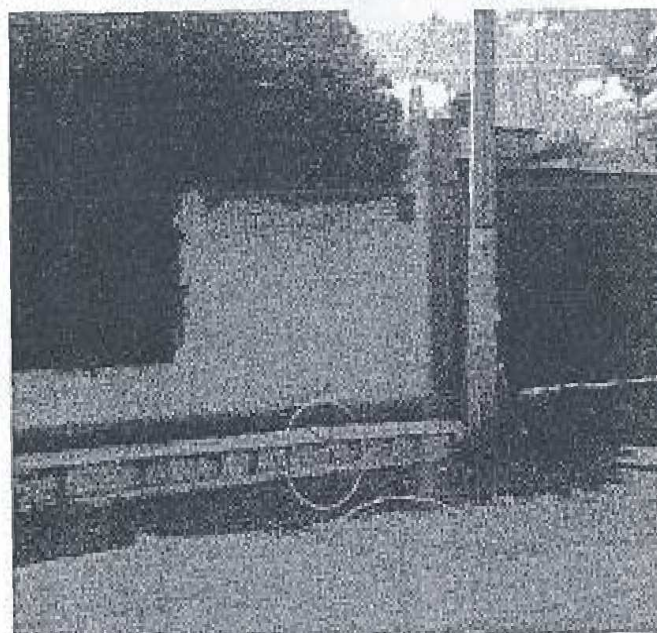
Fisura en la banqueta y muestra su continuidad sobre la carpeta asfáltica.
